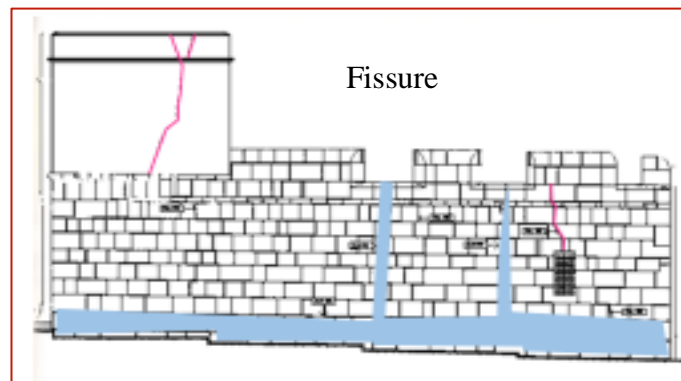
Fissuration au niveau surélévation de la façade est
